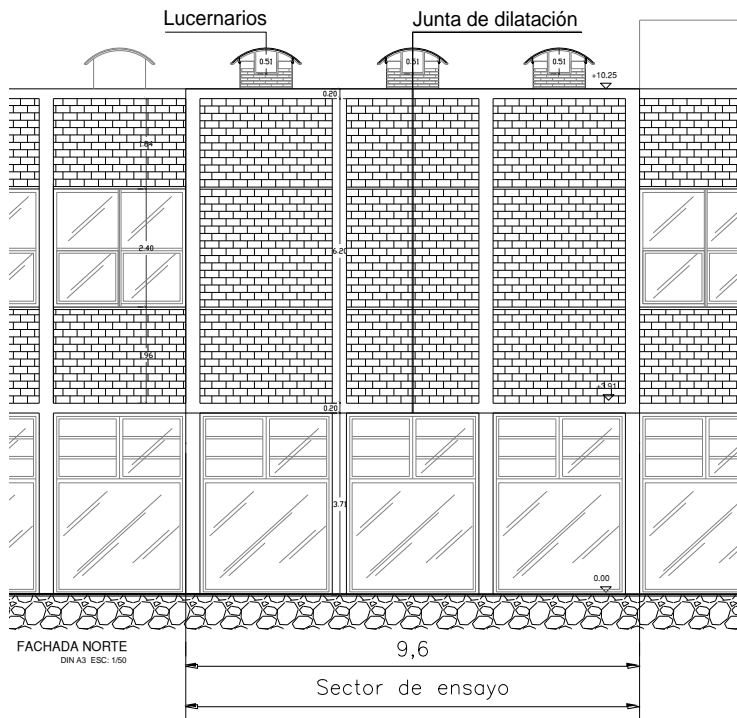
Detalle en alzado del tramo de fachada (D')
